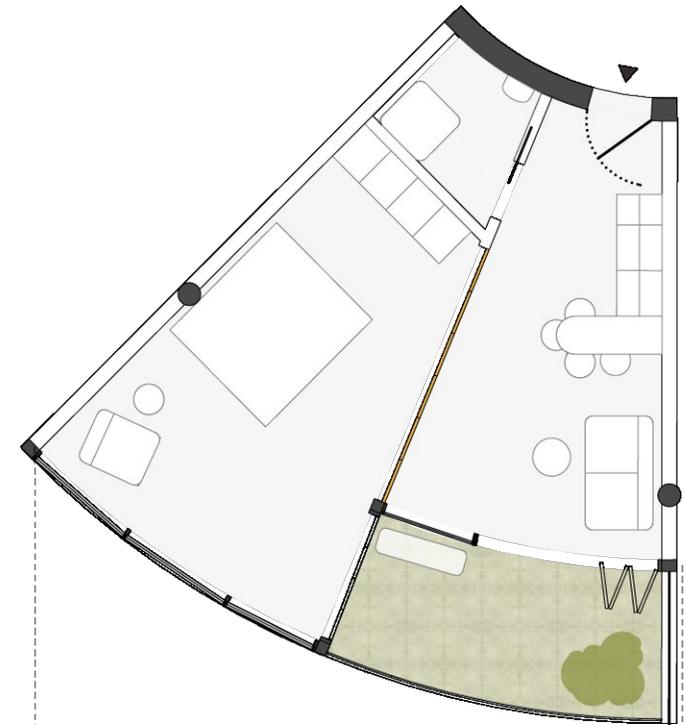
Grundriss Wohnung Typ A.c
